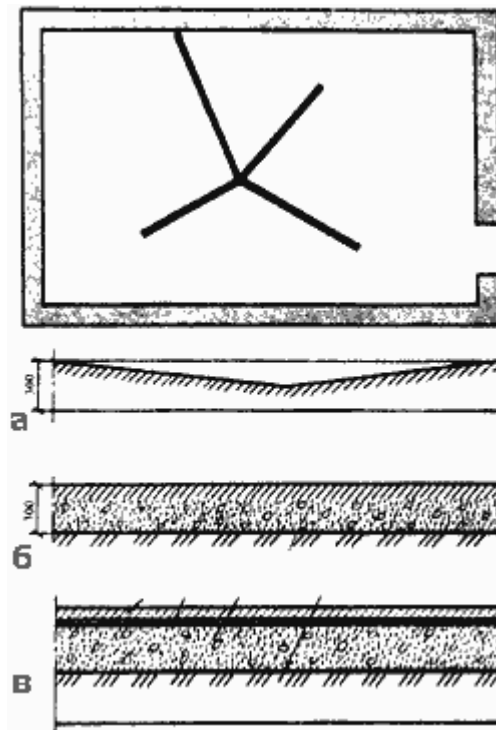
Последовательность ремонта бетонного пола: а - удаление просевшего грунта и замена его новым; б - трамбование нового грунта со щебнем или устройство песчаного основания; в - устройство новой конструкции пола; 1 - цементный раствор; 2 - гидроизоляционный слой; 3 - бетонная подготовка; 4 - новый утрамбованный грунт.
